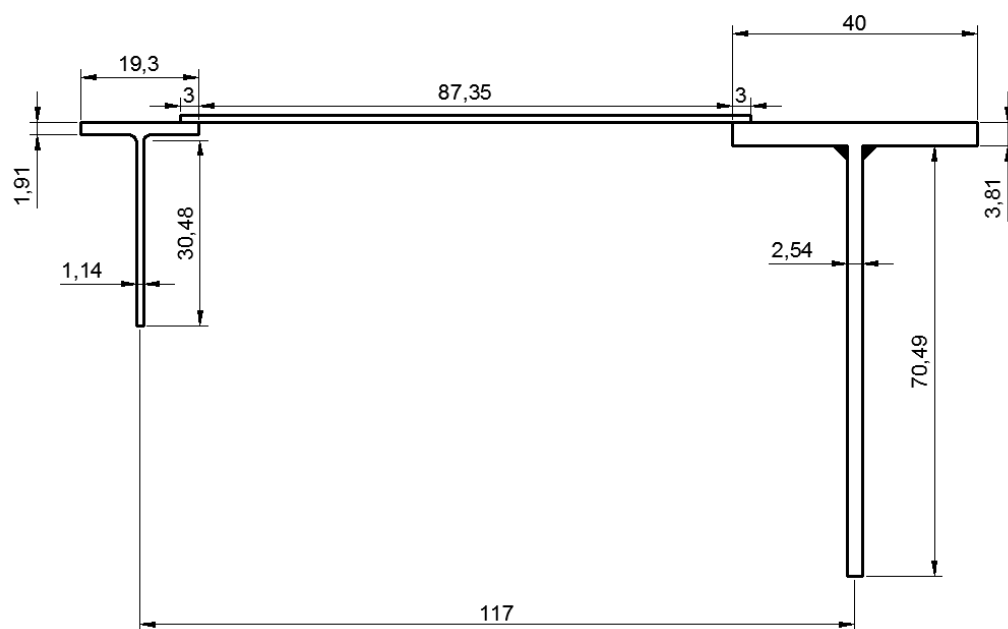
Sección equivalente de la trabe carril con la placa de respaldo y la viga secundaria
